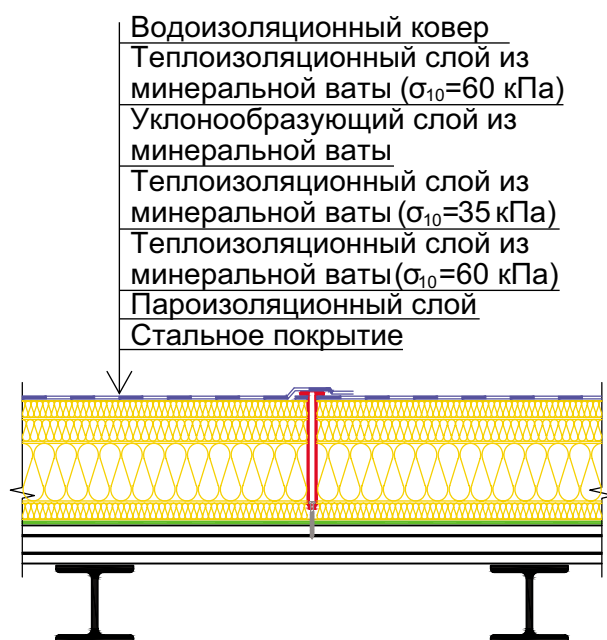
Кровля с теплоизоляцией из минераловатных плит по стальному покрытию из профилированного листа
